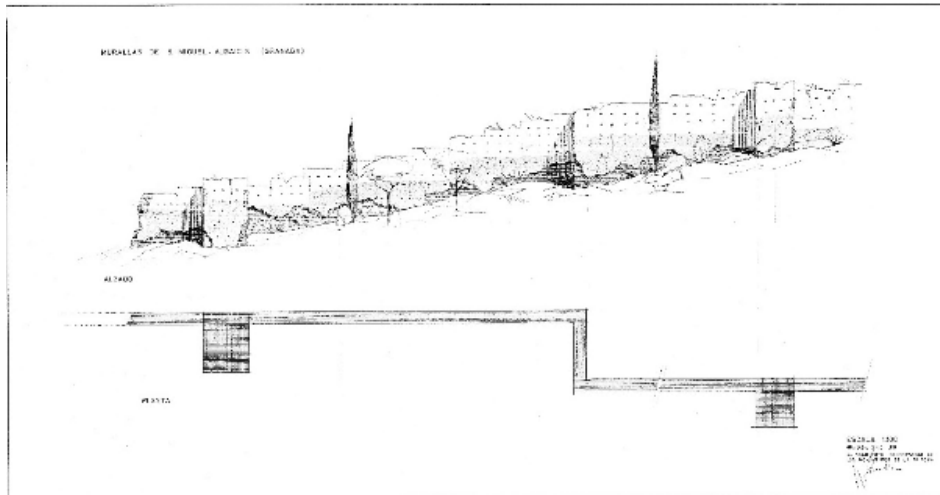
F. Prieto-Moreno Pardo, 1968. Murallas Albaicín – Granada. Alzado. Planta. Obras de recalce y restauración de murallas (...) y en la cerca de Don Gonzalo. AGA, Sección Cultura, 26/00134.
